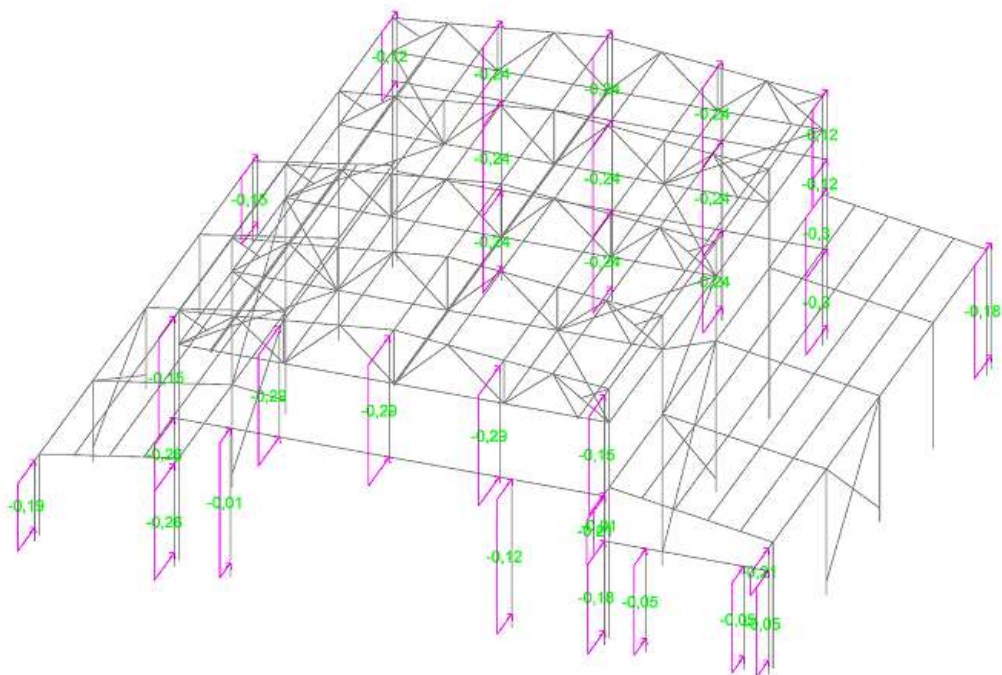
Схема загрузки ветровой нагрузкой спереди
